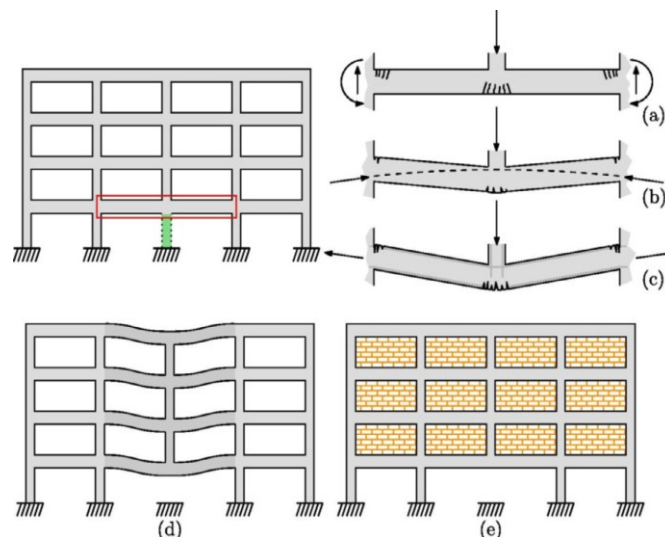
Mecanismos resistentes en pórticos de hormigón armado: a) flexión, b) arco, c) catenaria, d) Vierendeel, e) aportes de elementos no estructurales. Fuente: (Elkady et al., 2024).
